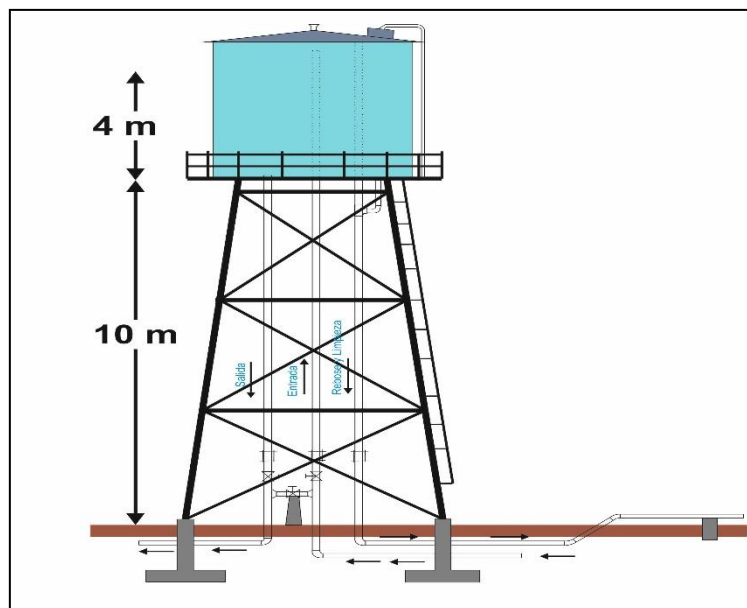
Tanque elevado metálico para retrolavado y servicio de la planta
